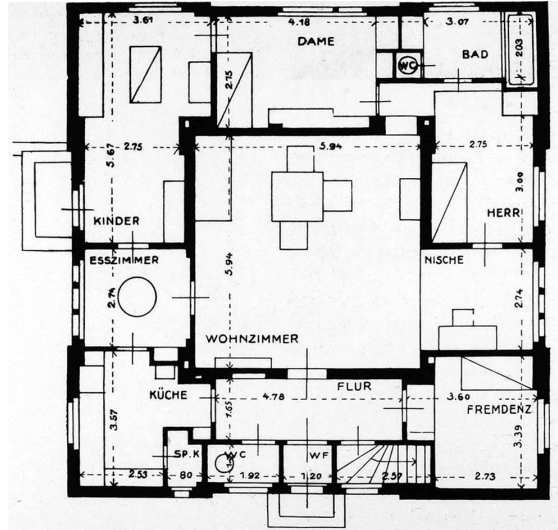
G. Mucbe, *Haus am Horn*, Grundriss, 1923
